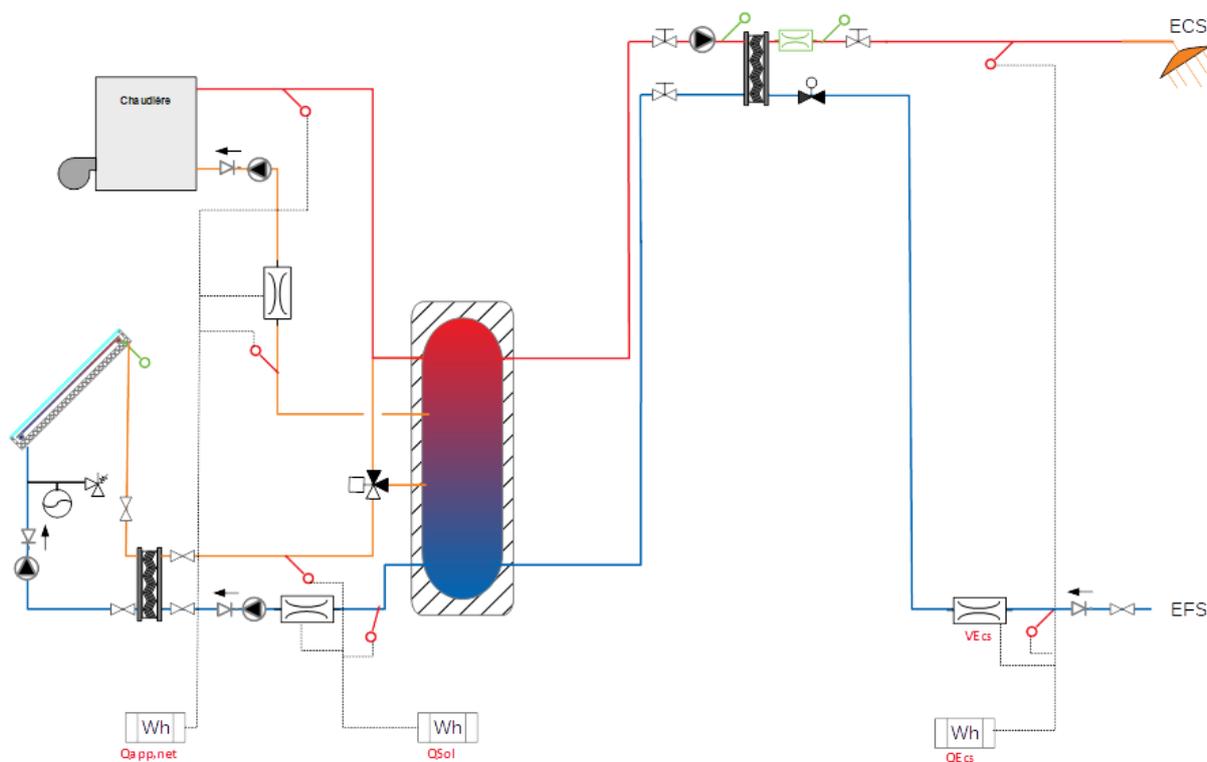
Schéma d'une installation solaire+appoint de préparation d'eau chaude sanitaire en instantané par échangeur à plaques avec ballon de stockage solaire+appoint
